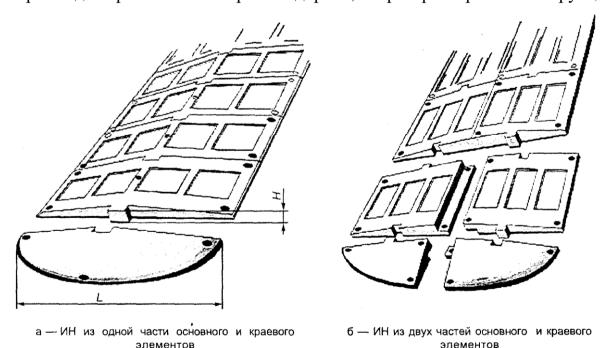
Конструкция сборно-разборной искусственной дорожной неровности
